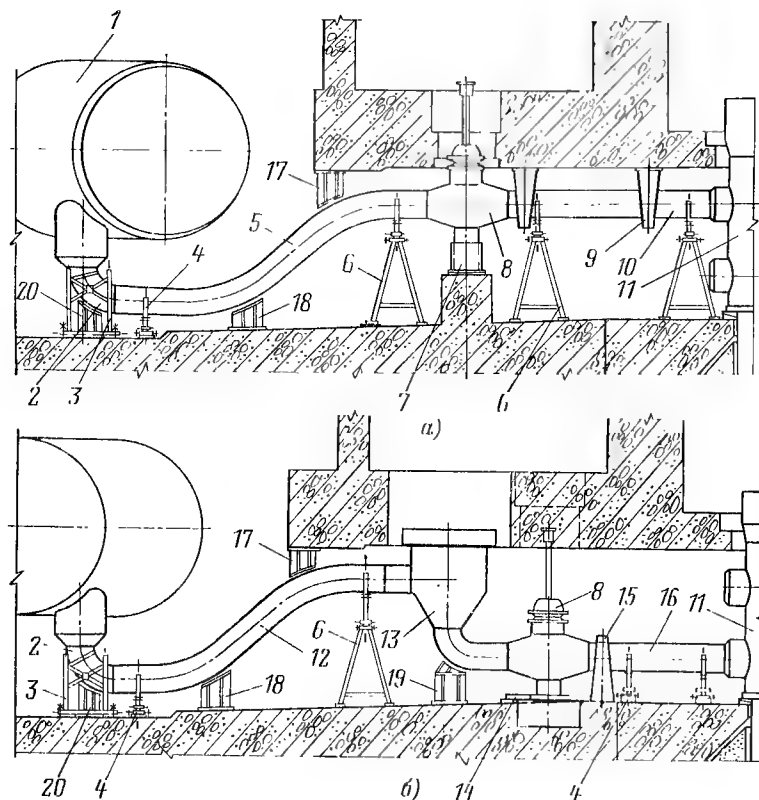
Монтаж трубопроводов главного циркуляционного контура ВВЭР-440.
